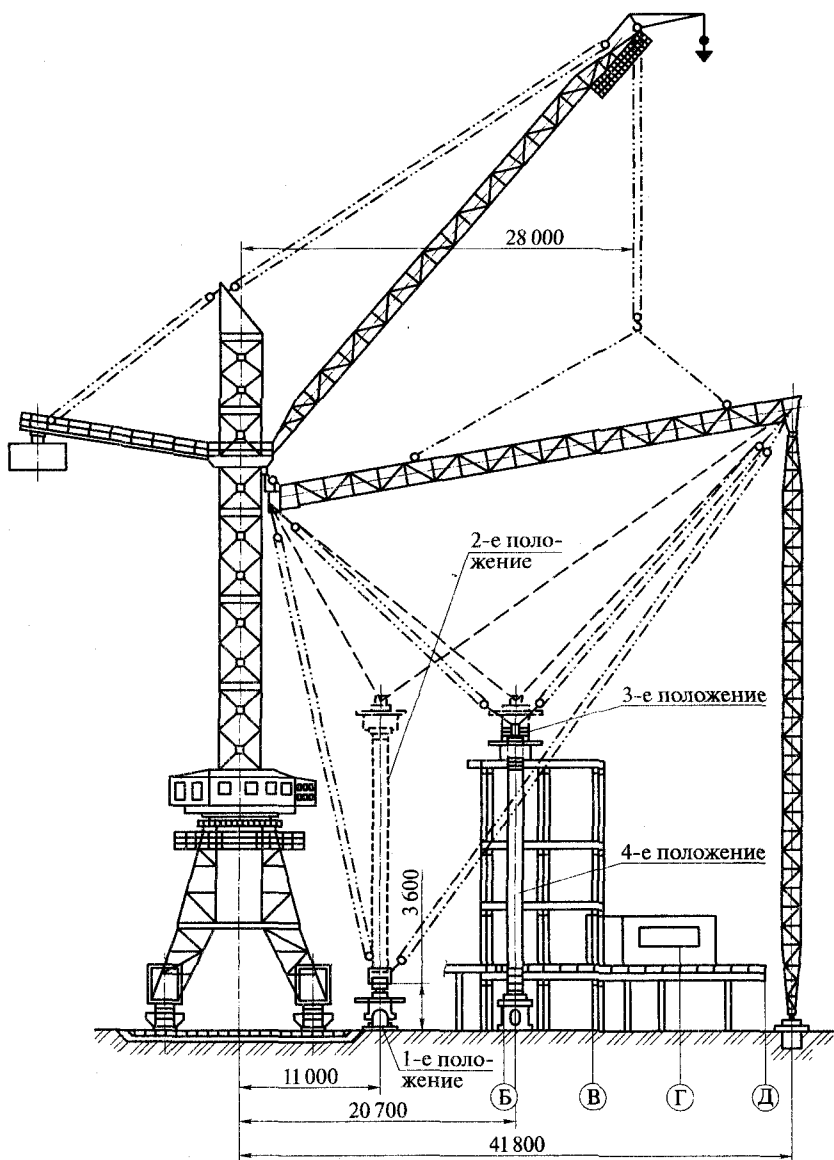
Монтаж оборудования башенным краном со специальной приставкой
